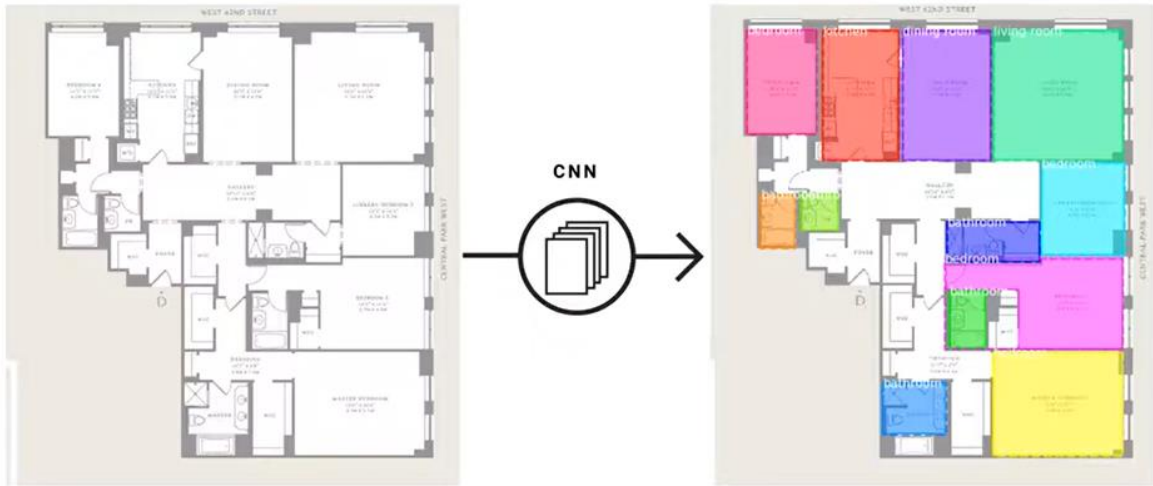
Kat Planı Öğretme ve Algılama Çalışma Aşamaları [56]
